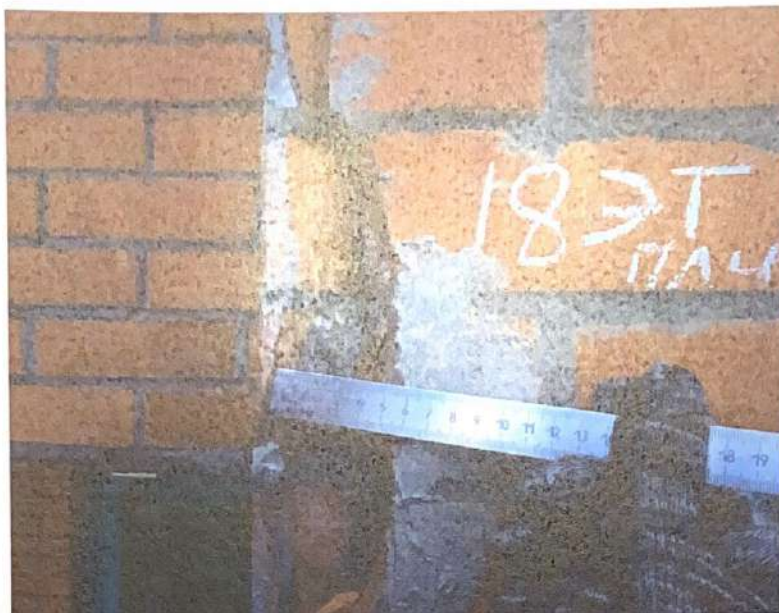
Секция 11. Фасад 2. Критическое разрушение кладки наружной версты.
